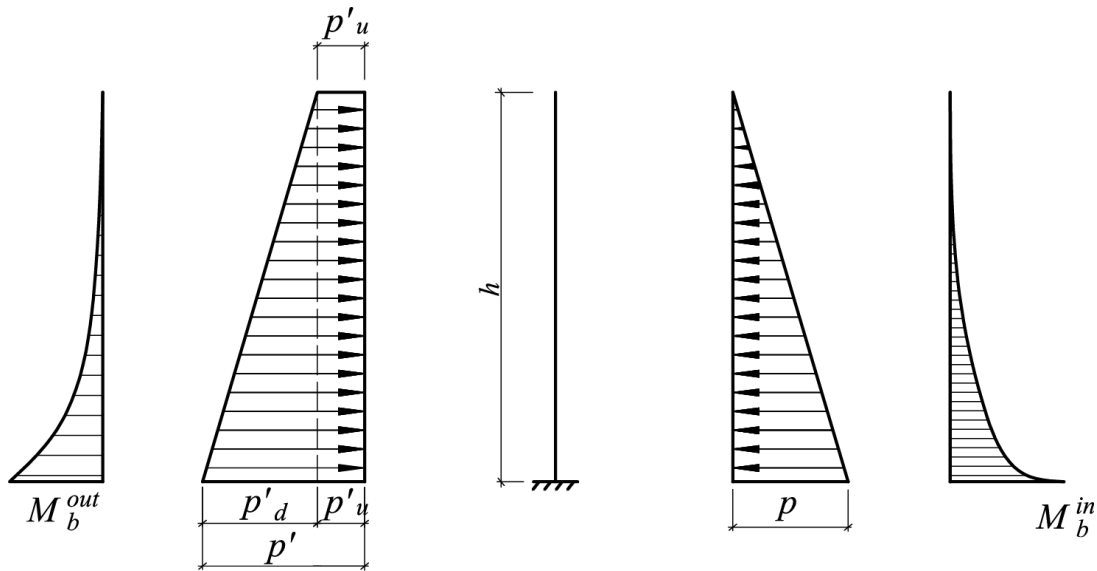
Эпюры изгибающих моментов для консольной расчетной схемы
